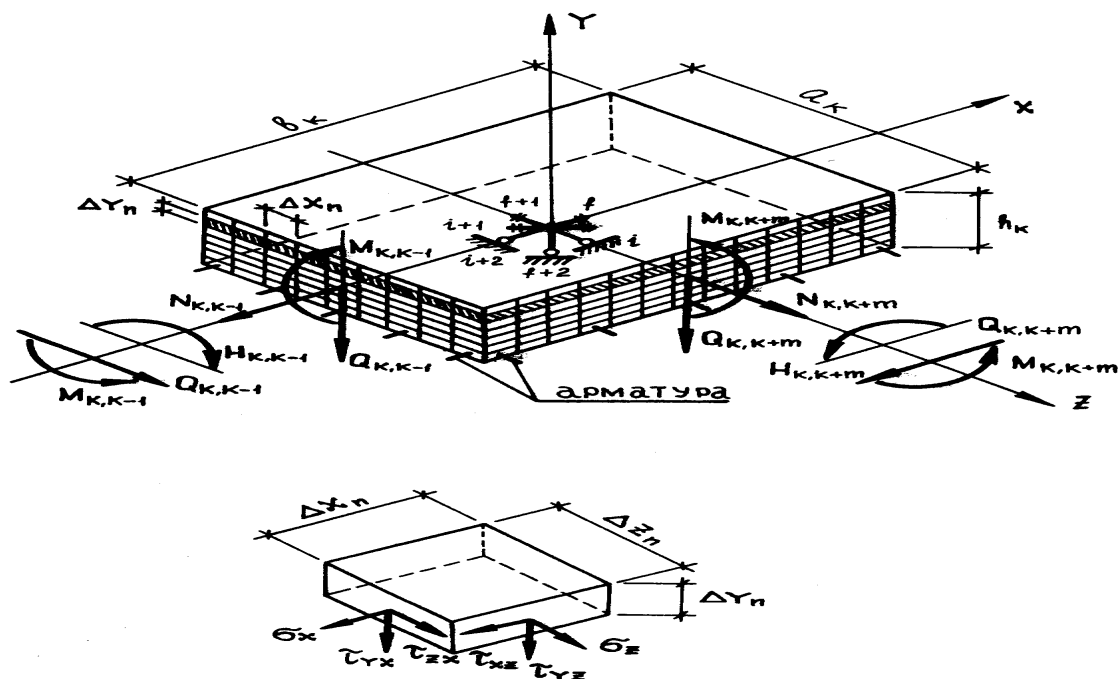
Расчетная схема по МСД для железобетонной плиты
